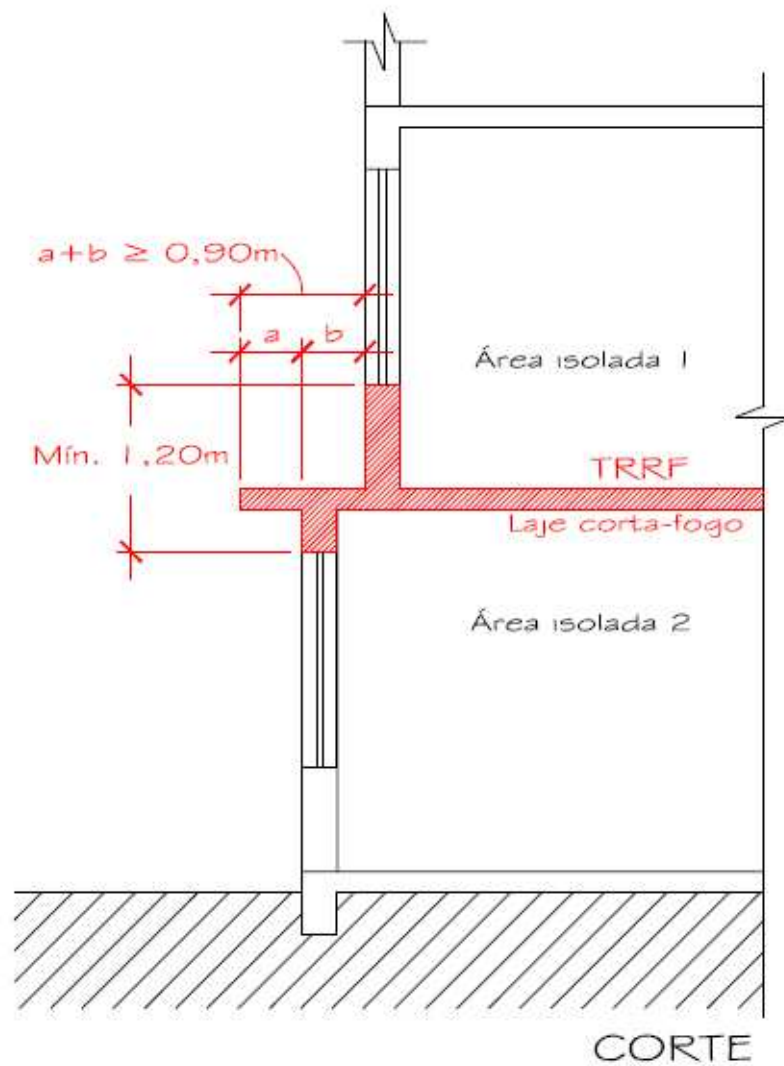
Distância vertical entre aberturas dotadas de aba ou marquises em conjunto com o recuo entre pavimentos isolados
